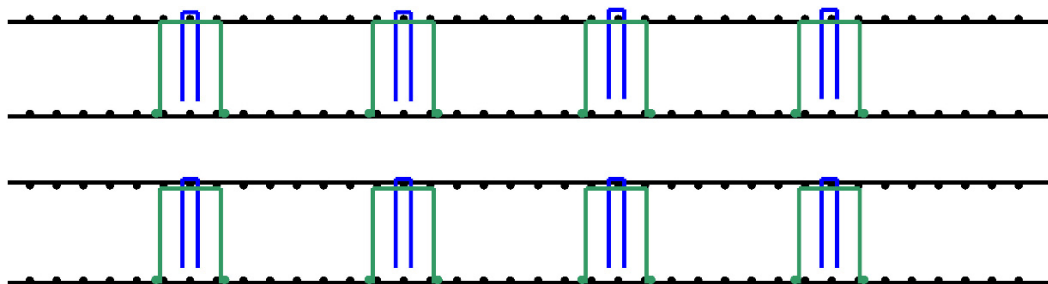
Die Schubbewehrung in einer horizontalen Platte, die die Aufbauphysik der Platte betrachtet.
